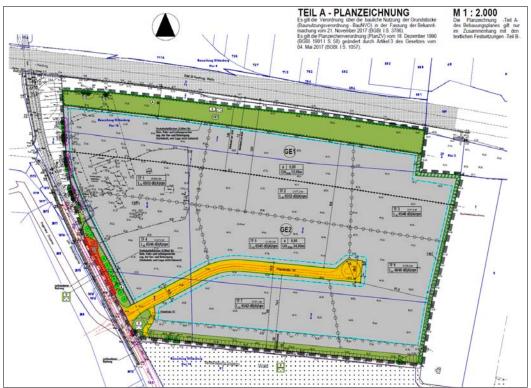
Planungsziele Wittenburg Bebauungsplan Nr. 18 Stand Entwurf
